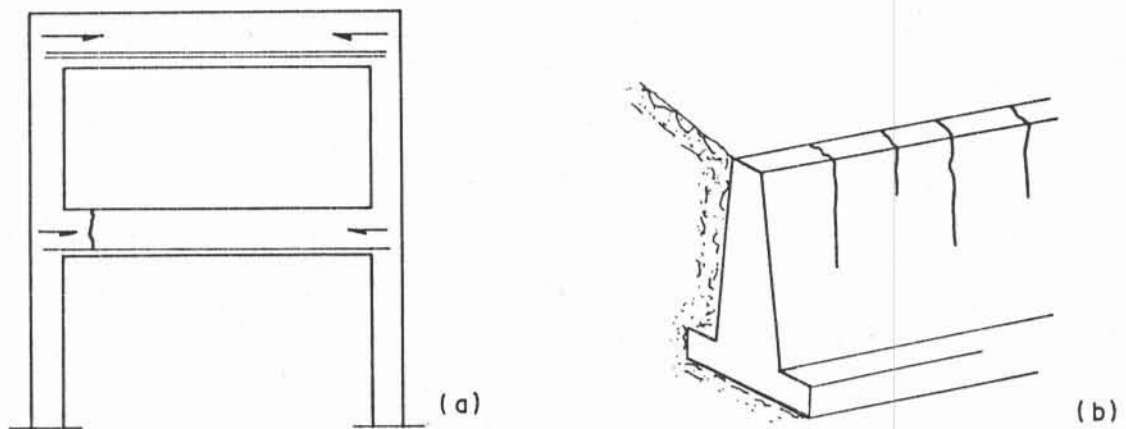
Fissuras produzidas por retração hidráulica (a) em pórticos de vigas com diferentes taxas de armadura e (b) em muros de arrimo (CANOVAS<sup>36</sup>).
